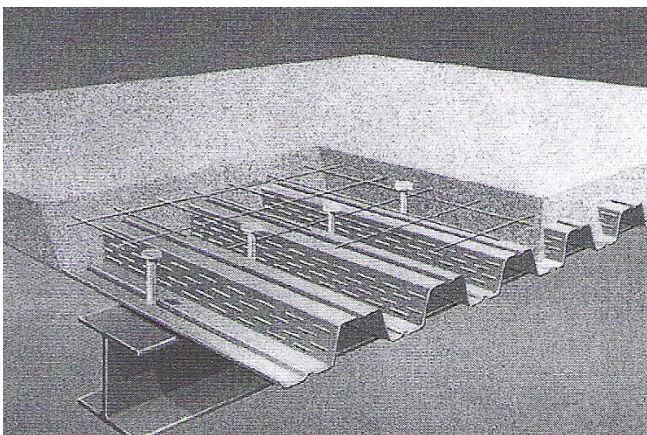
Viga mista com forma metálica (*steel Deck*) [120]
